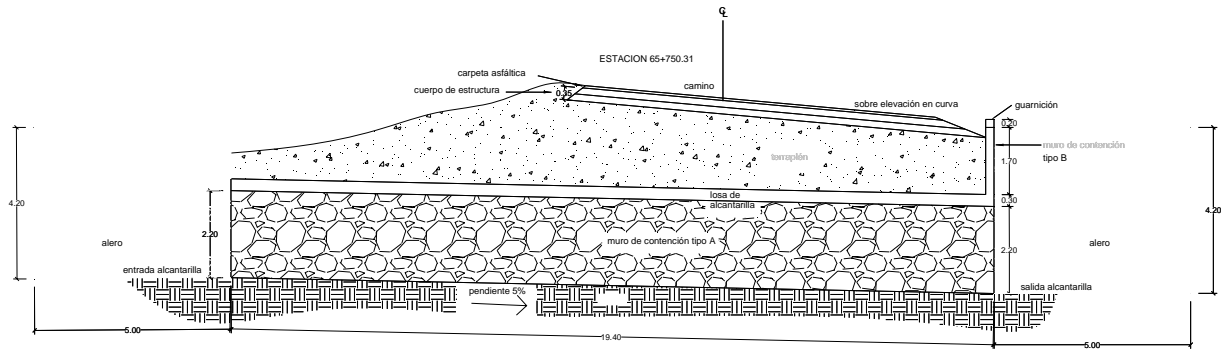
Corte longitudinal A-A' de la alcantarilla Km. 65+750.31
